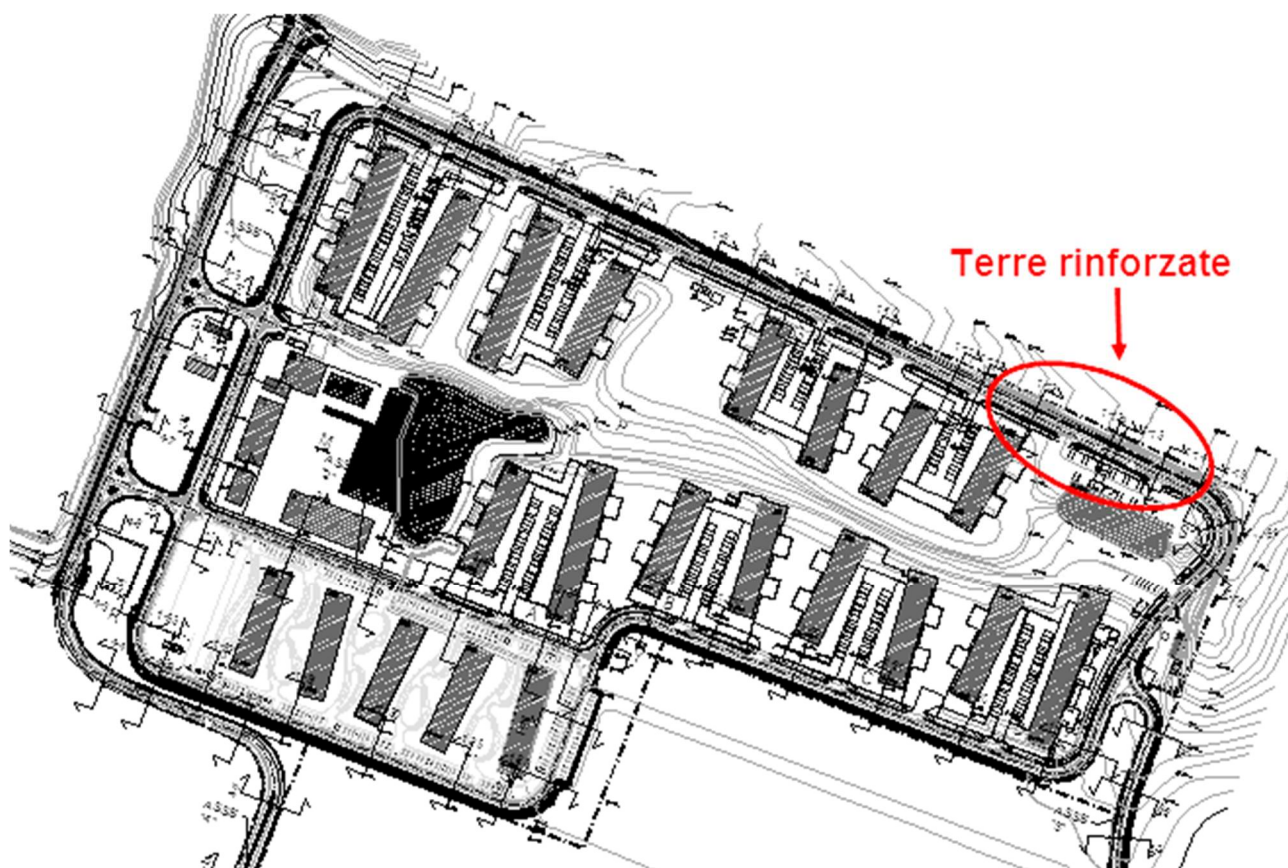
Planimetria area intervento con individuazione delle terre rinforzate
